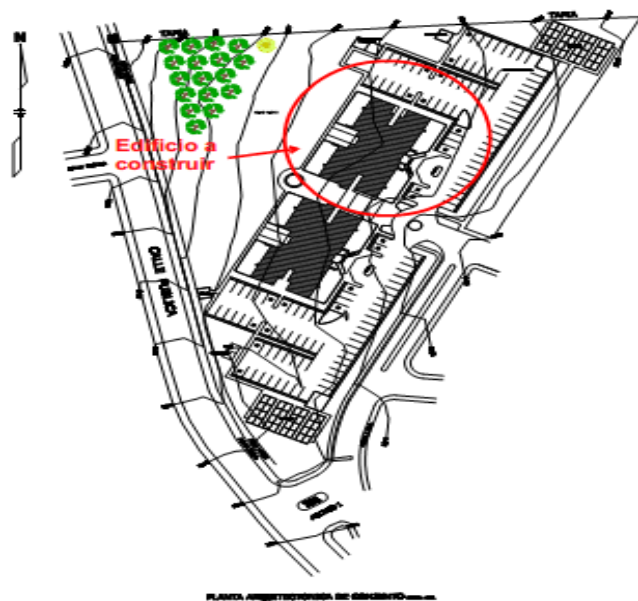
Plano de conjunto. Fuente: Planos arquitectónicos Proyecto Torres de Velarde
